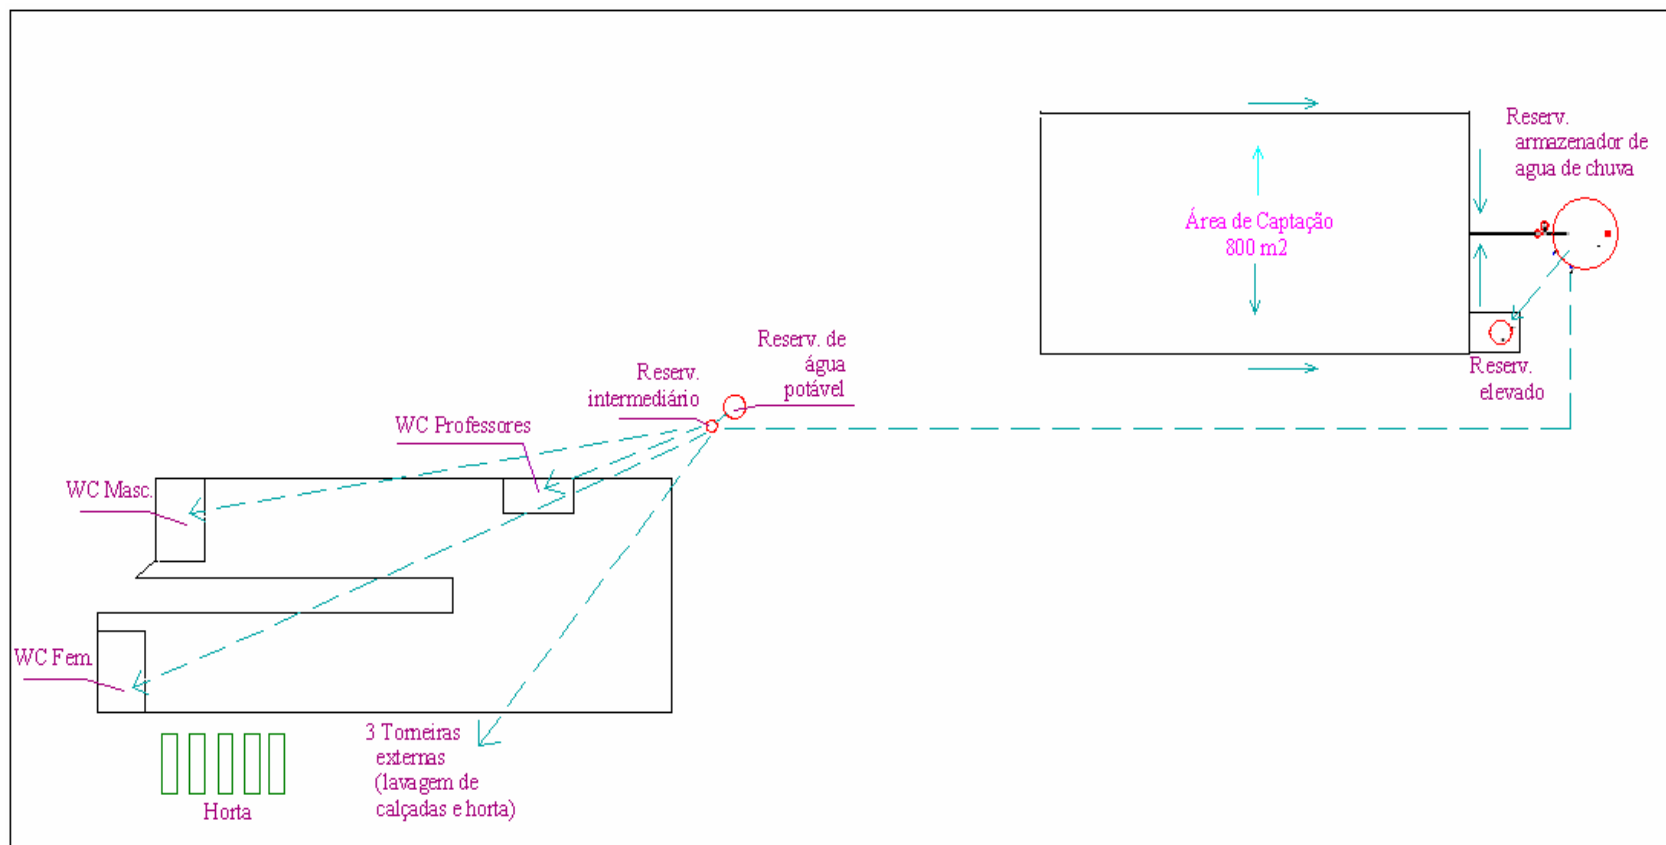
Croqui do sistema de captação de água de chuva (vista em planta)
